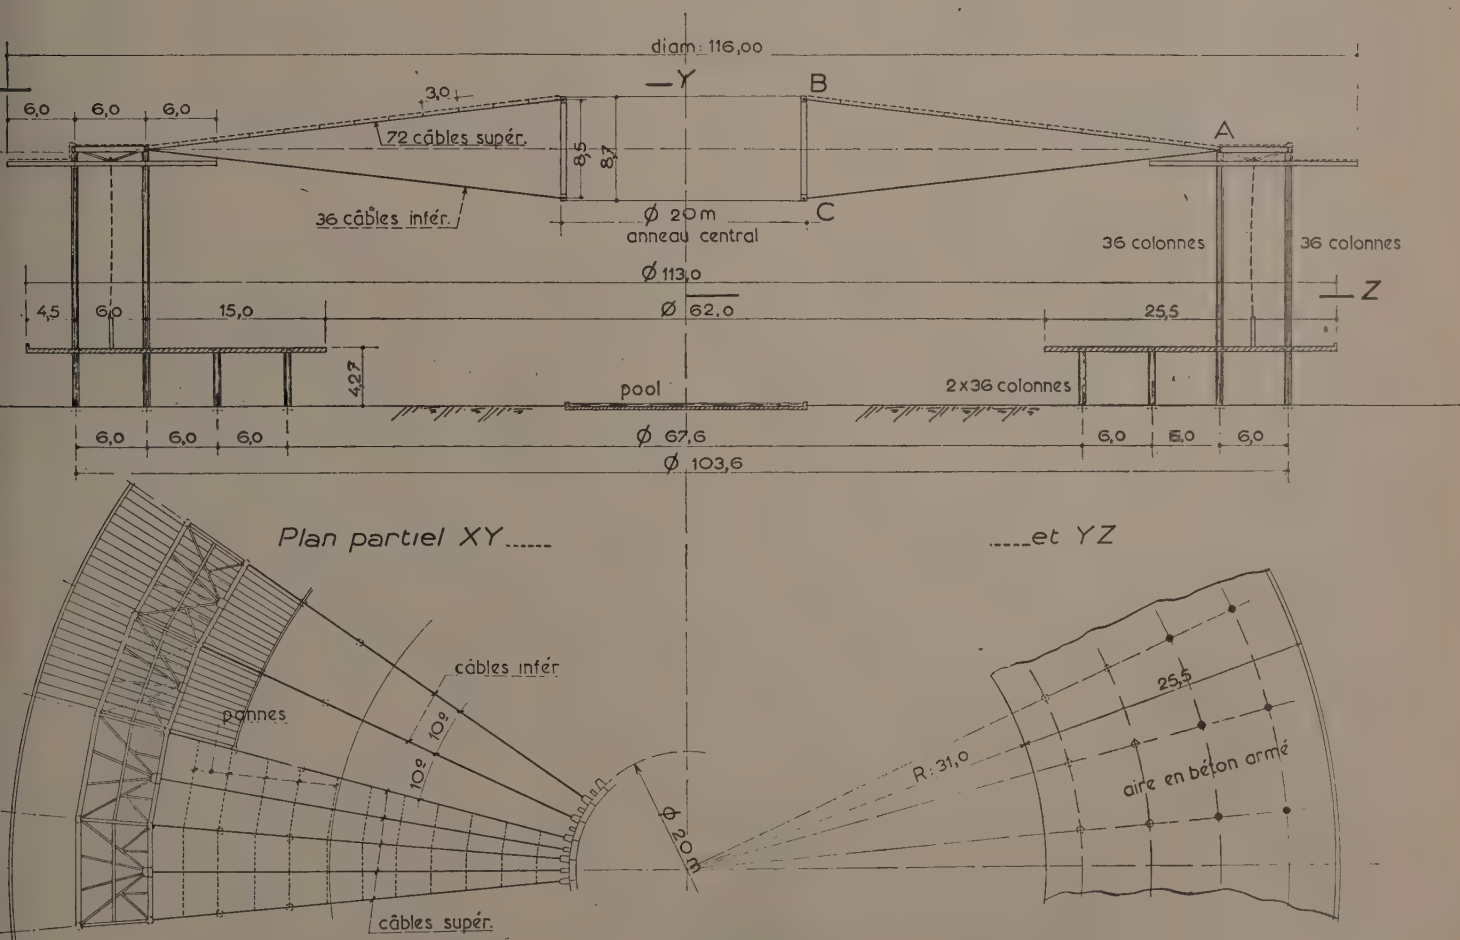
Pavillon des États-Unis. Coupe et élévation.
